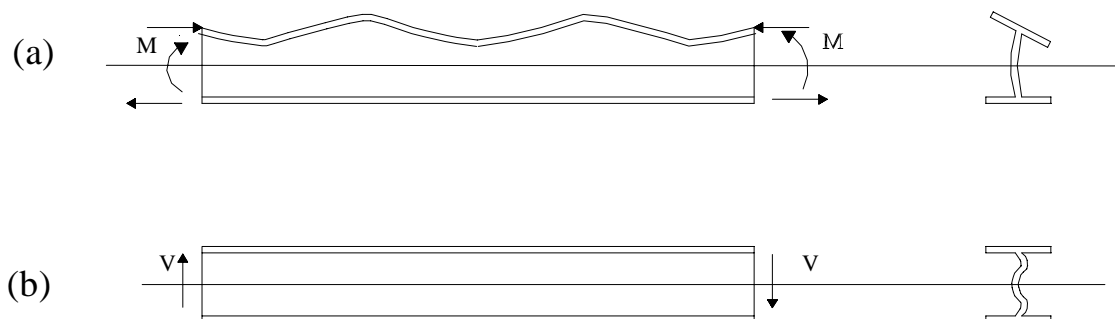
Flambagem local: (a) flambagem do flange comprimido, (b) flambagem devido ao cisalhamento.
